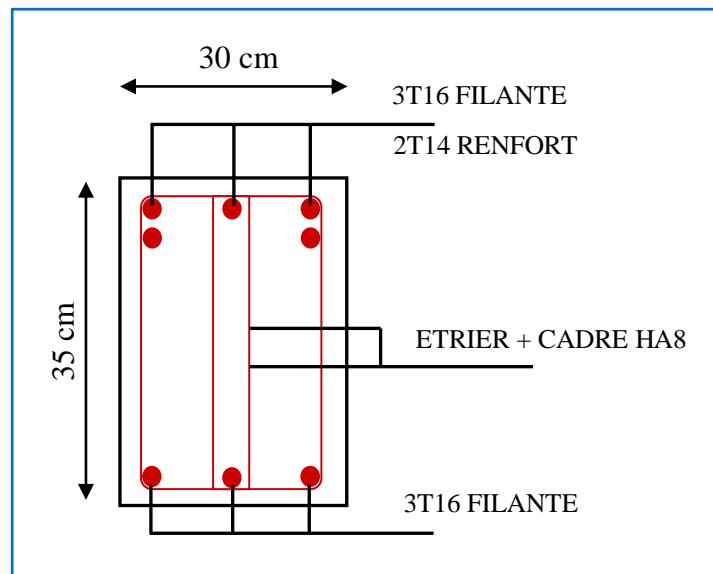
Ferrailage des poutres secondaires sur appui.
